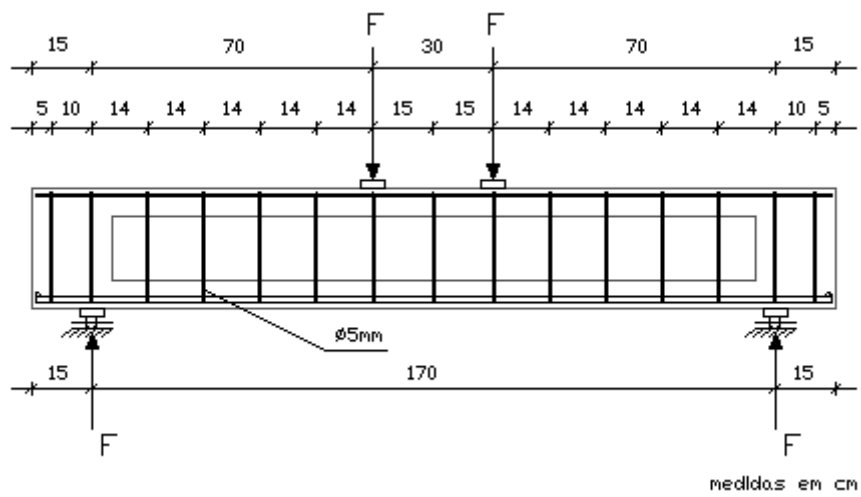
Posição dos estribos, cargas e apoios da viga I-250 (LEITE JÚNIOR, 2000)
